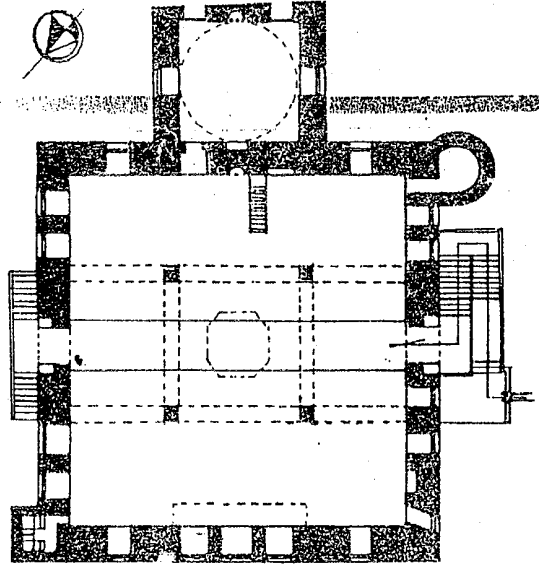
مسقط أفقي لجامع داود باشا بالقاهرة .
